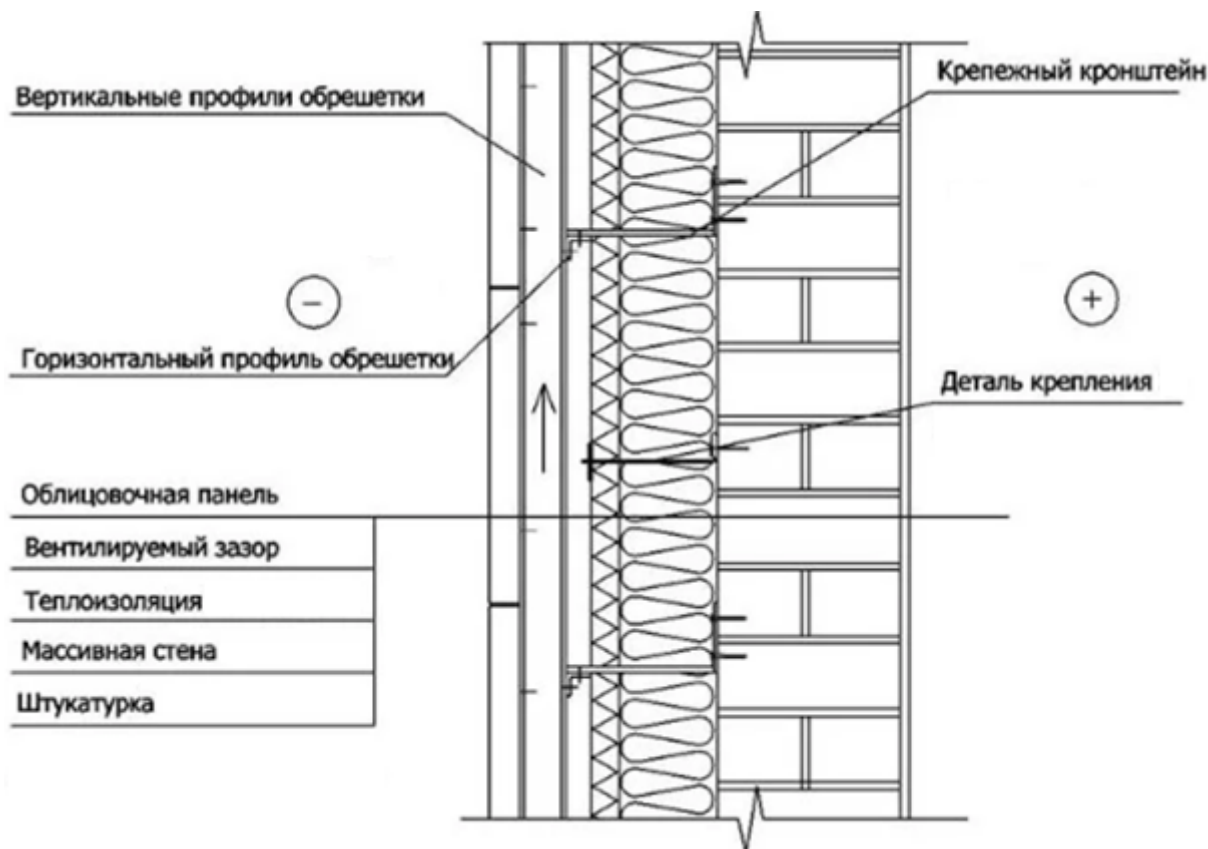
Утепление массивной стены с облицовкой металлическими фасадными панелями
